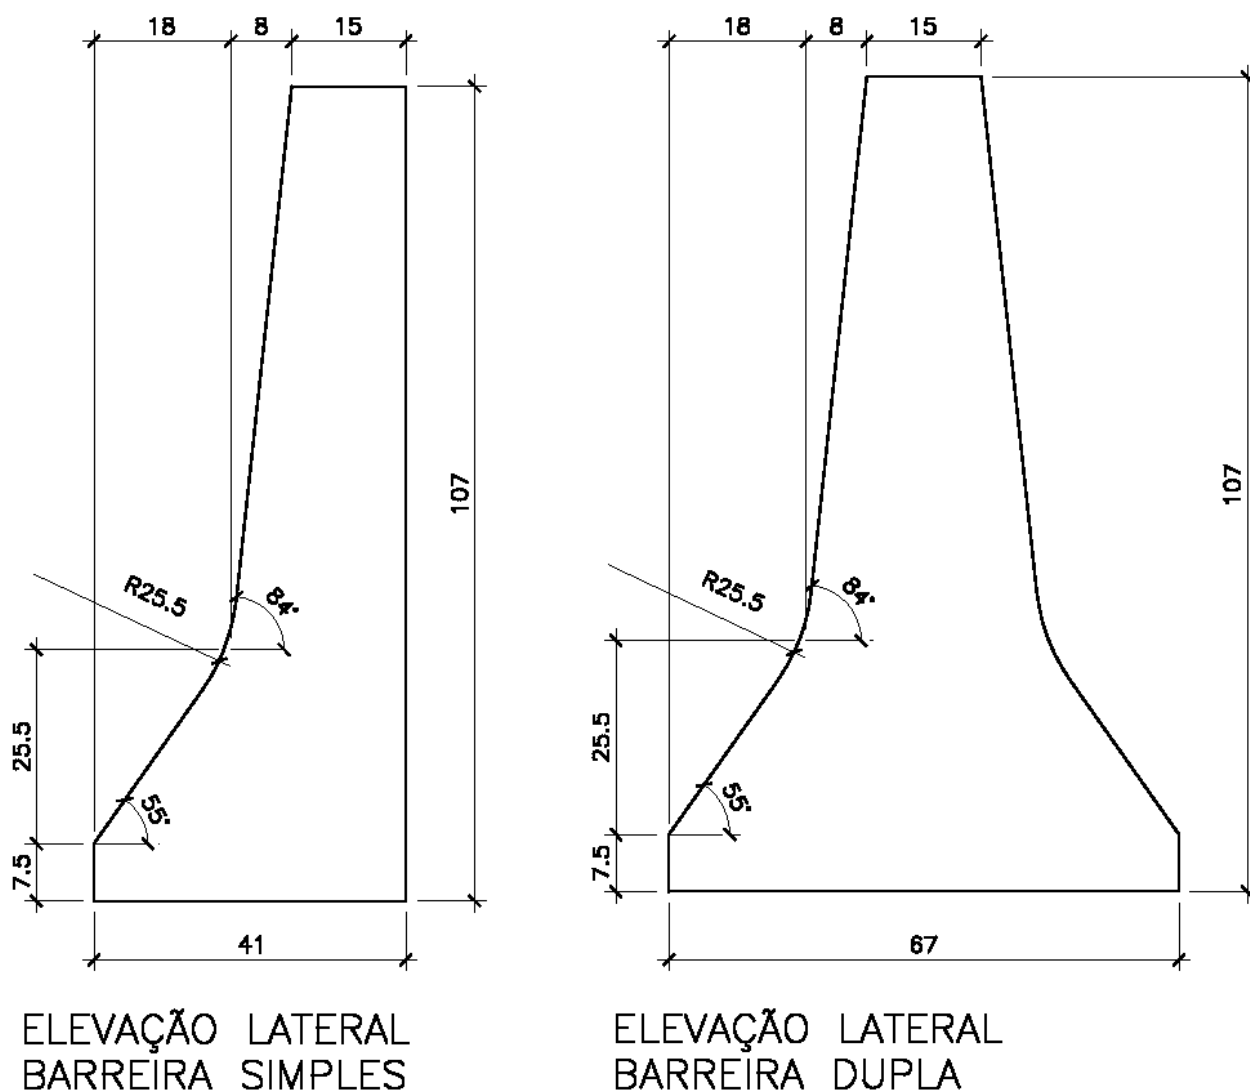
Geometria da barreira de concreto armado tipo New Jersey apresentado na NBR 14885. Fonte: ABNT (2016).
